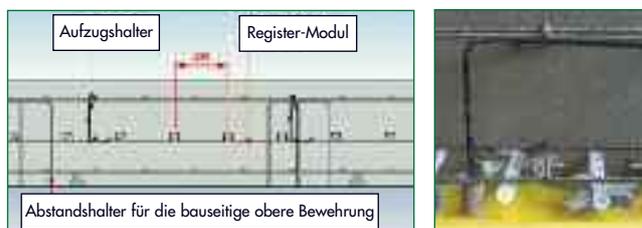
Detail der Deckenkonstruktion mit Kunststoffrohren im Betonkern (links) oder in Oberflächennähe
